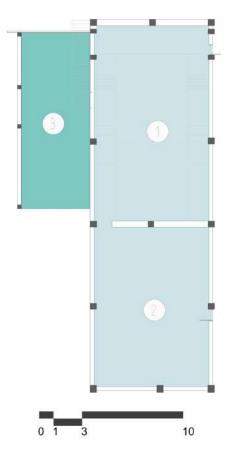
Planta 1 Bloque 59. Fuente: Equipo de diagnóstico.
